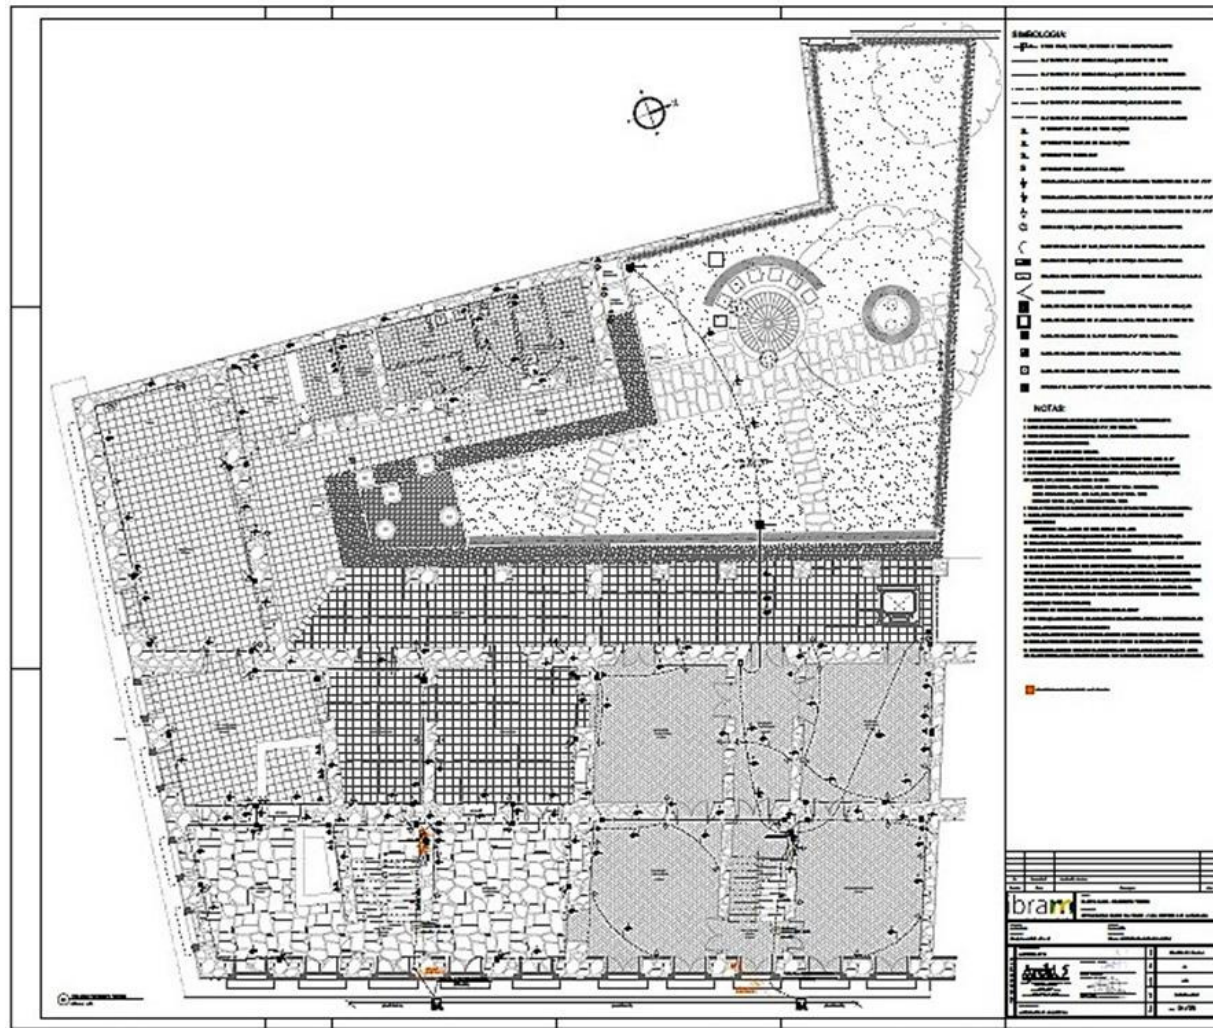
Planta baixa dos quintais dos sobrados nº 7 e nº 15. Fonte: ARCHI 5, 2017.
